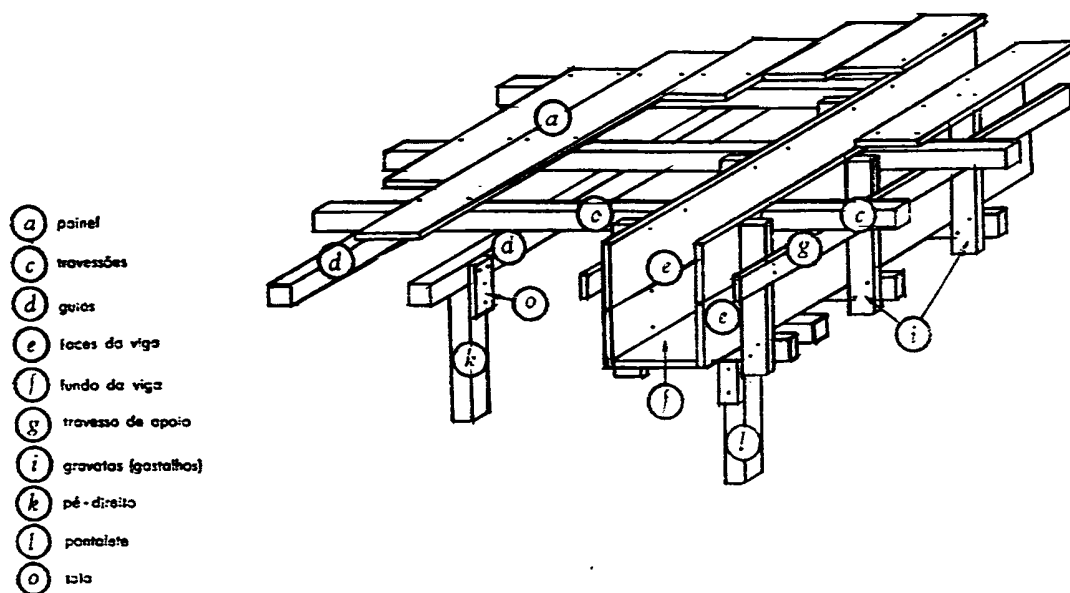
Ligação de painel de laje com a viga, quando as tábuas são paralelas à viga (Fonte: ABCP, 1943).
